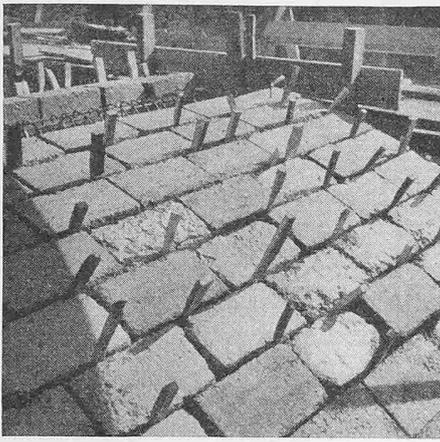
Rekonstruktion des Gewölbes 4 in Beton-Molloni
